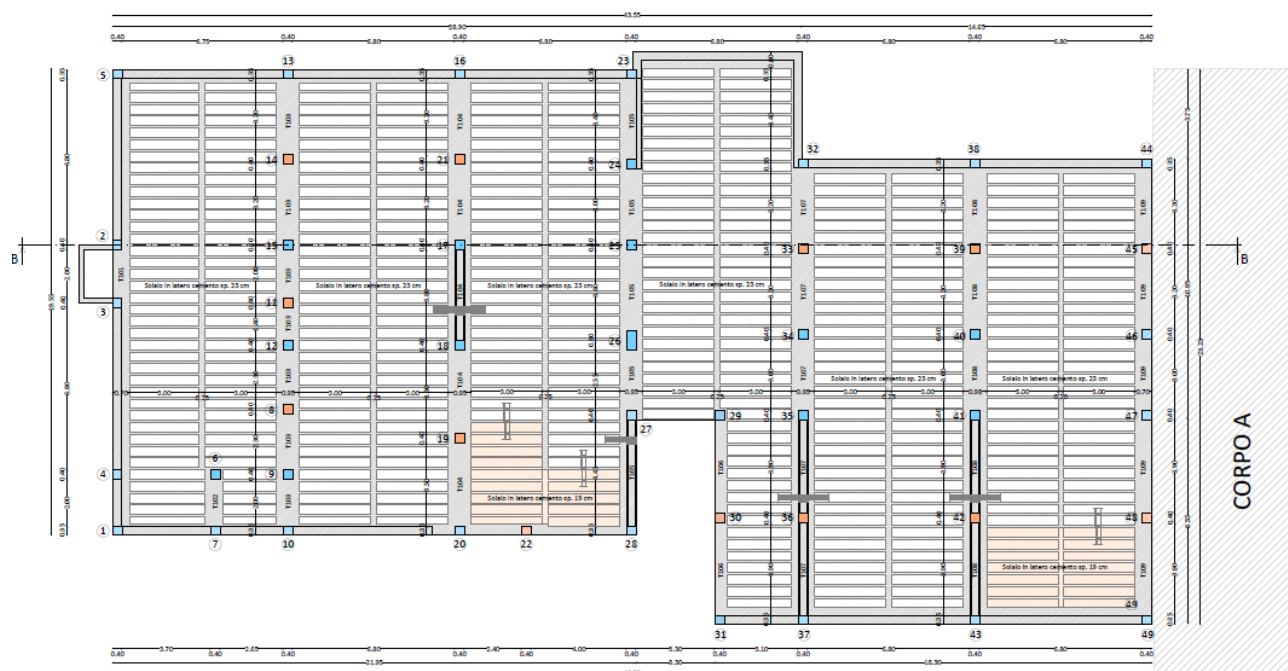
Blocco B-Planimetria Struttura Piano Terra Esistente.
